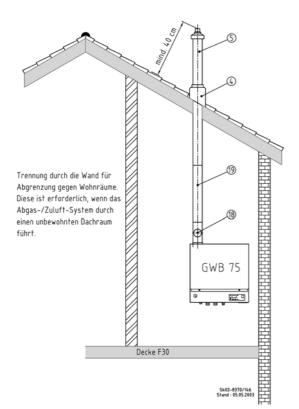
Installationsbeispiel C<sub>33X</sub> Raumluftunabhängiger Betrieb, Dachheizzentrale mit der Durchführung senkecht durch ein Schrägdach
